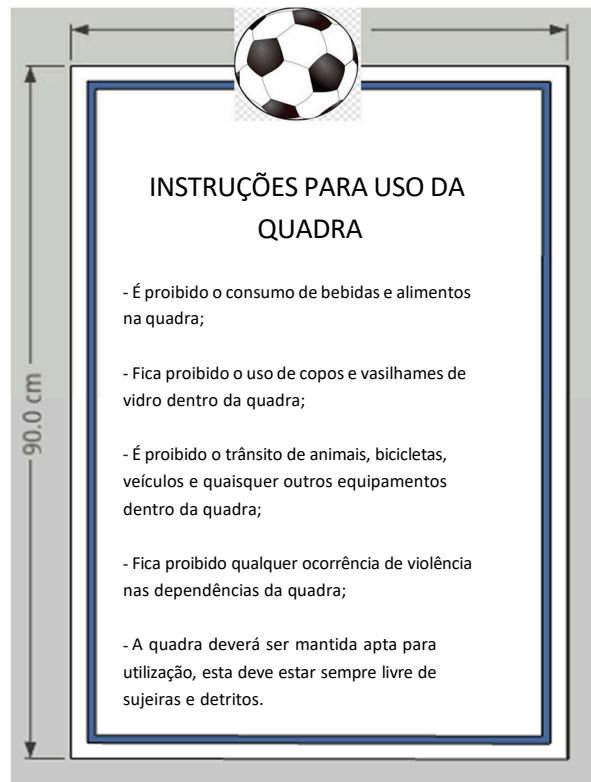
Detalhe Ilustrativo de placa de instruções (Fonte: Autor/2025)
